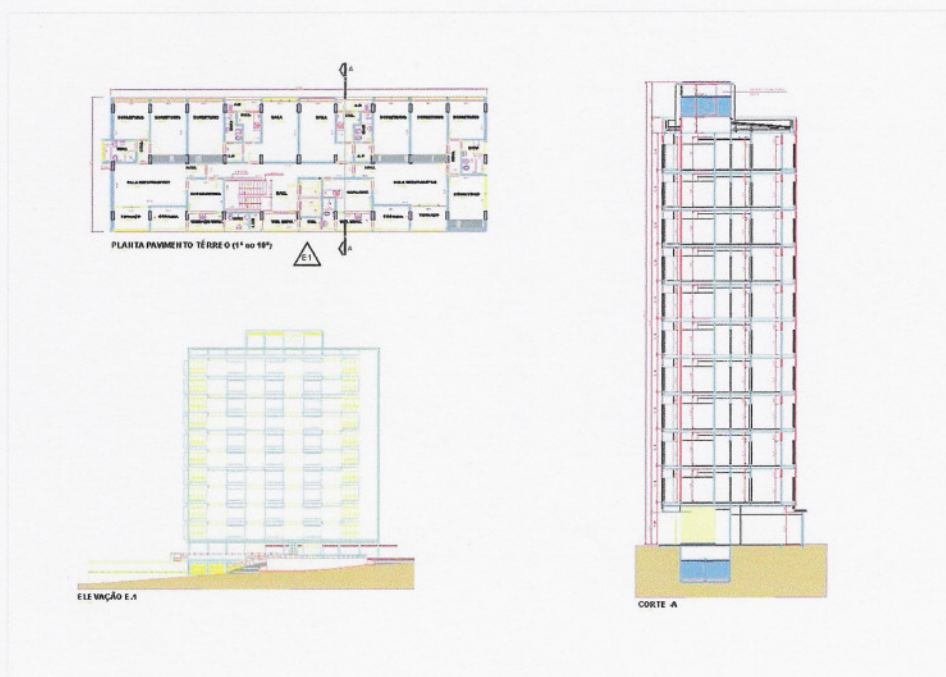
Planta do pavimento tipo/corte/elevação do Edifício Brasil Portugal
